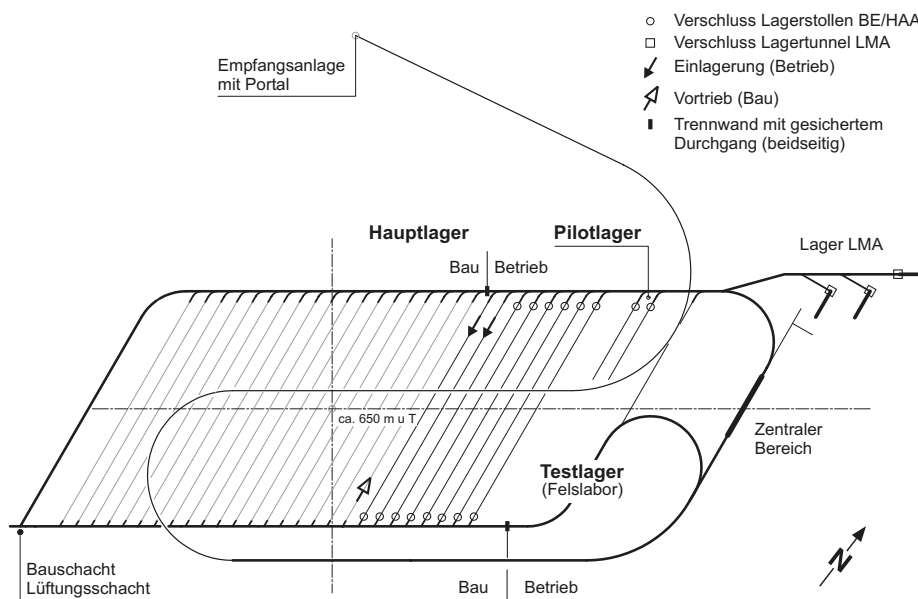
Einlagerungsbetrieb und Lagererweiterung – Lagerbetrieb und Bauetappe 3
